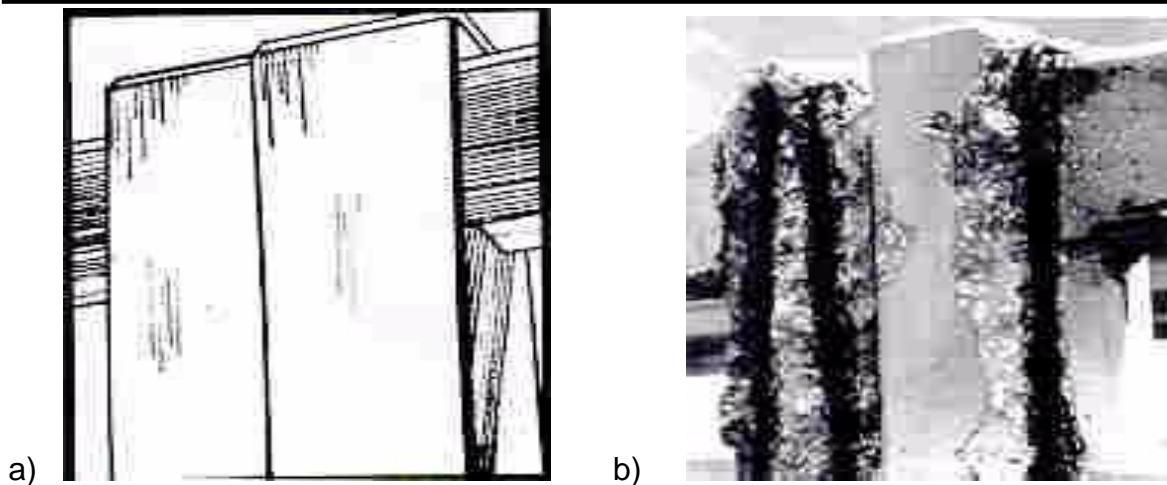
Fenómeno de corrosión en estructuras de concreto reforzado. a) estructura intacta, b) estructura manchada y corroída.
